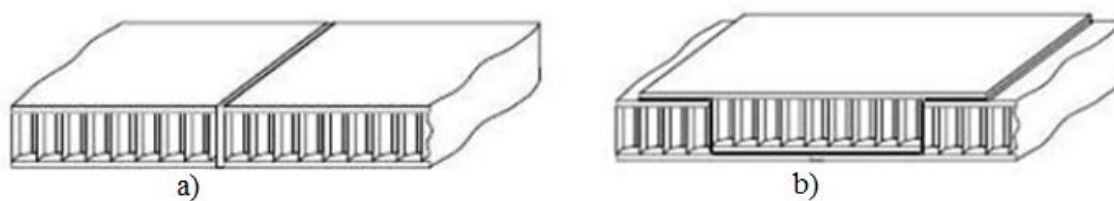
a) Ligação entre painéis com preenchimento da junta; b) Ligação por encaixe, adaptado de [13]
